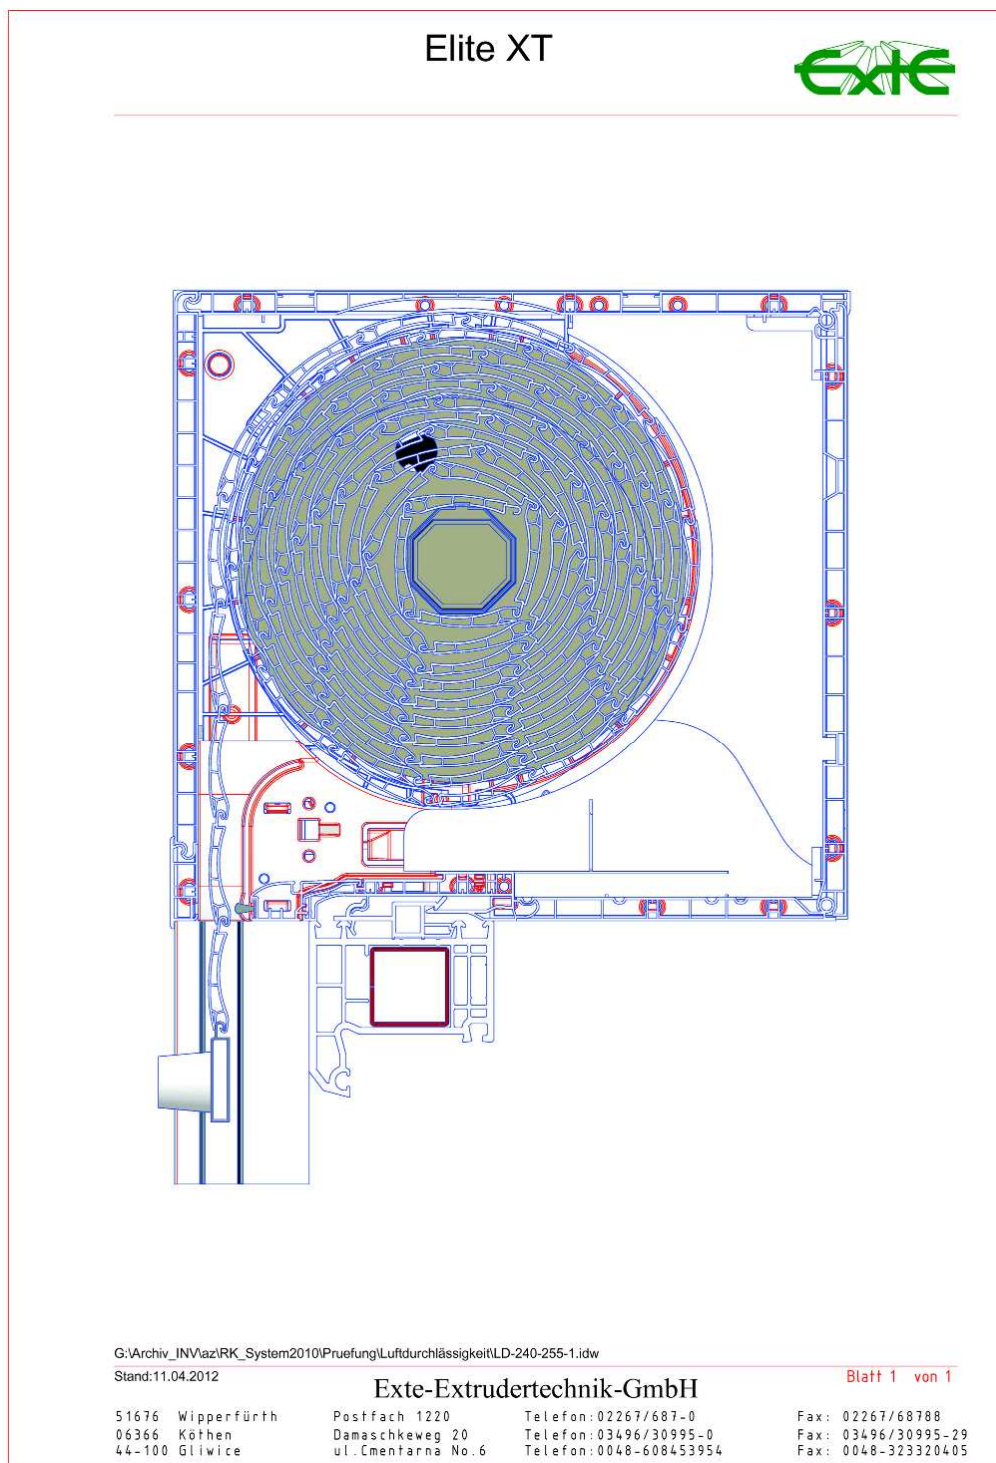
Zeichnung Probekörper Vertikalschnitt rechtwinklig zur Fensterebene
